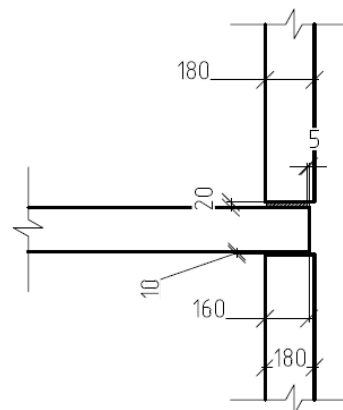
Платформенный стык с односторонним опиранием плит перекрытий
